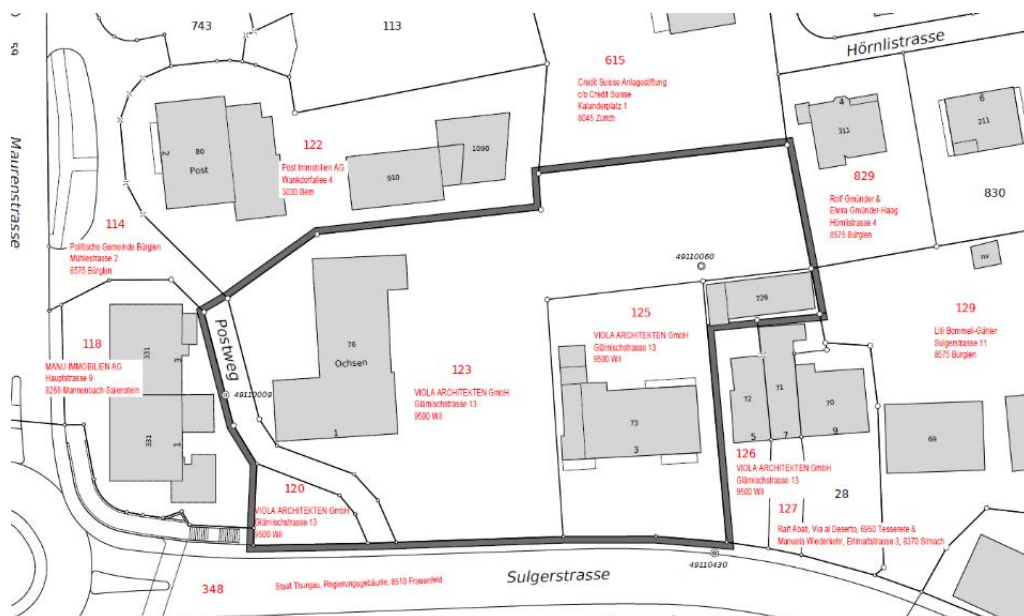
Geltungsbereich gemäss Einleitungsbeschluss vom 26.03.2019. Plan: i+geo ag, Stand März 2019.
